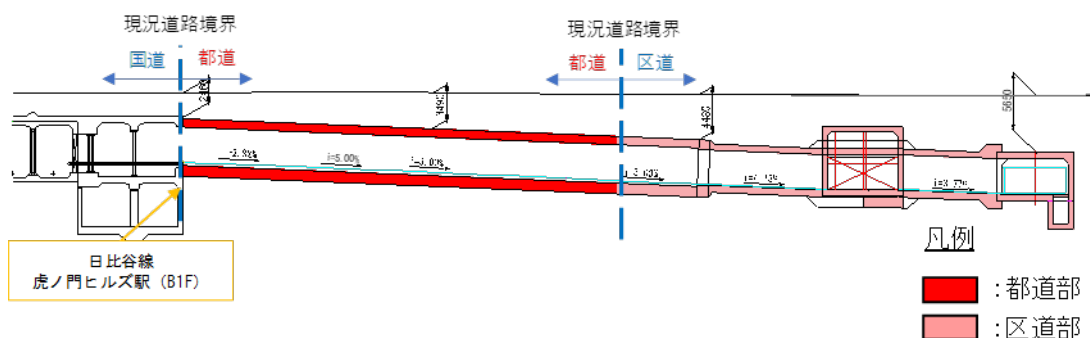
地下歩行者通路（東京メトロ施工監理実施部分）縦断面図
